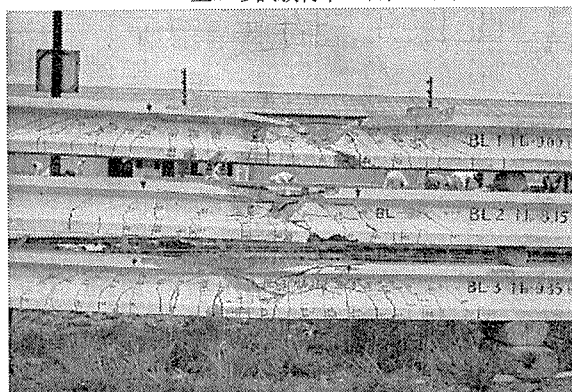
(c) 試験桁ひびわれ発生および破壊状況
